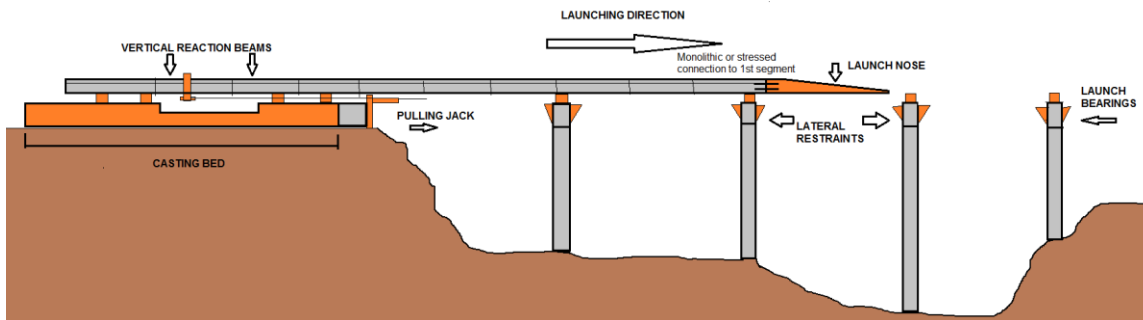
Proceso de construcción de un puente por empuje. Fuente [13]
